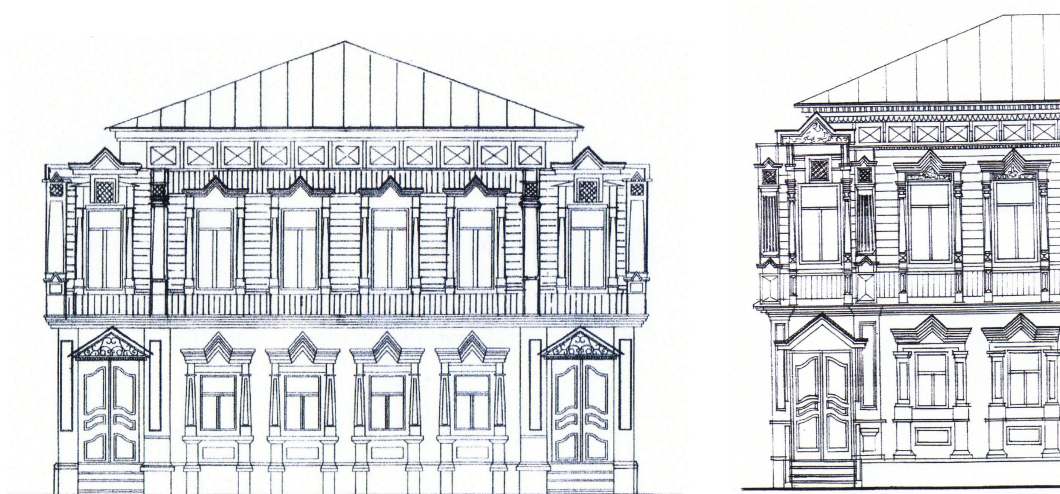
Ул. Ключевского, 55. Главный фасад. Фрагмент фасада.
